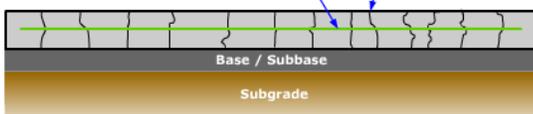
Detalles del CRCP. Fuente: Pavement Interactive (2007).
